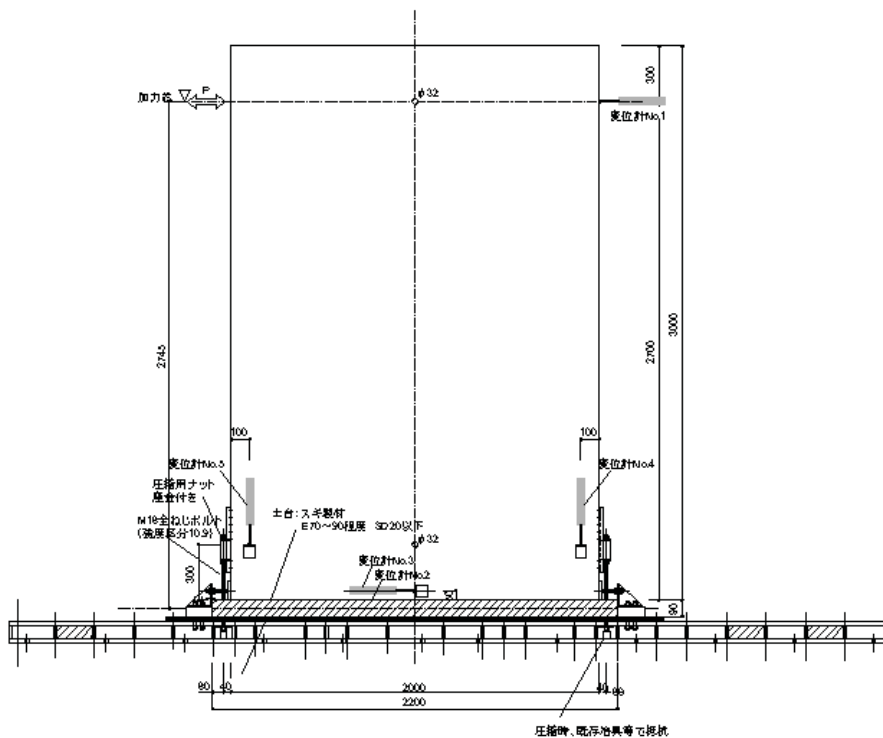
HD 金物 (2m 幅耐力壁) 試験体立面図 (HD2-1)
